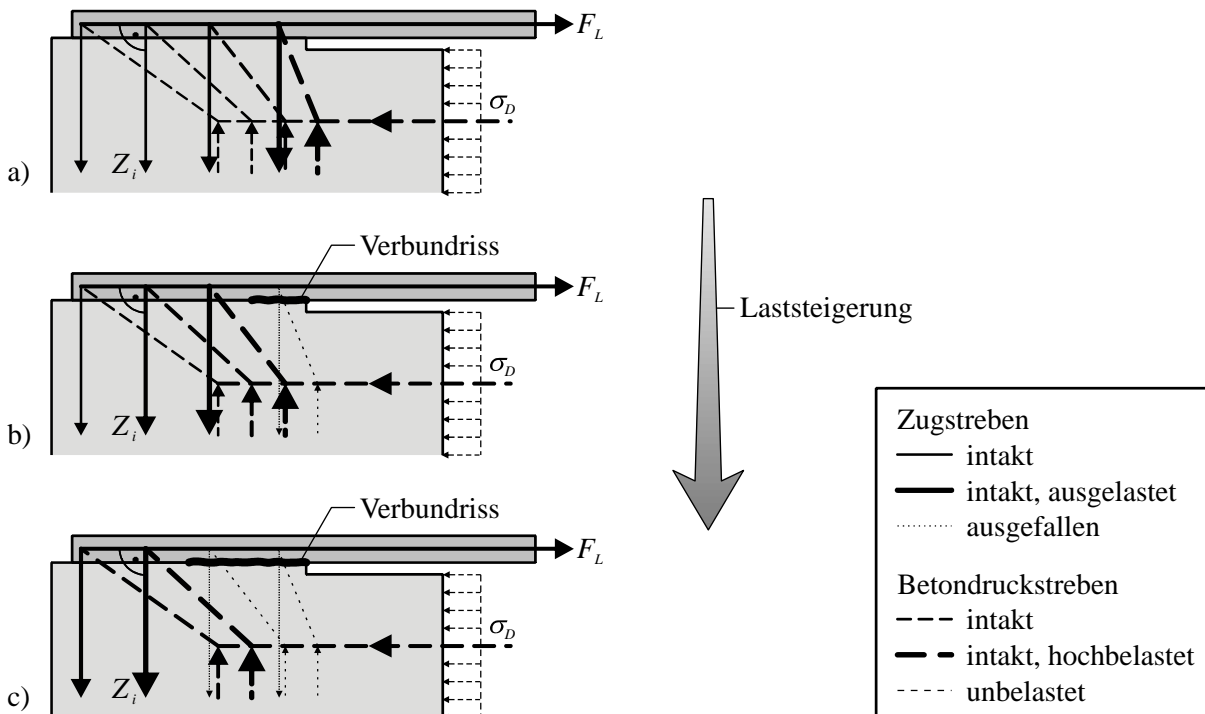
ausfallende Zugstreben bei Verbundrissbildung
